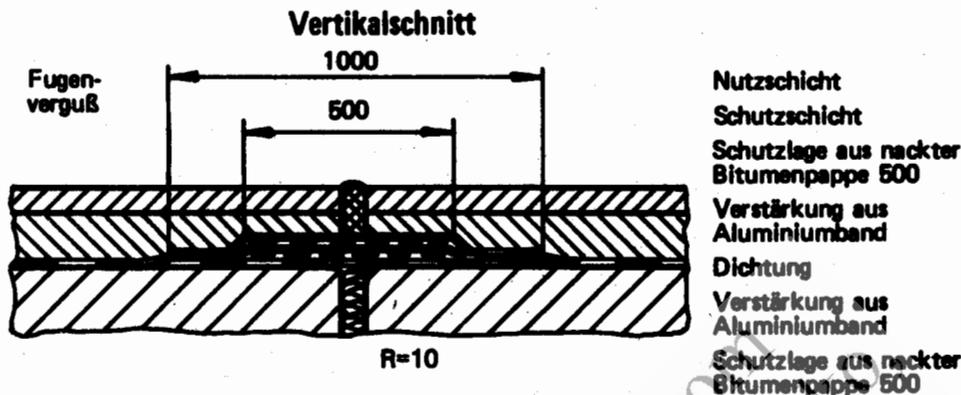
Bewegungsfuge mit ebener Dichtungsverstärkung
